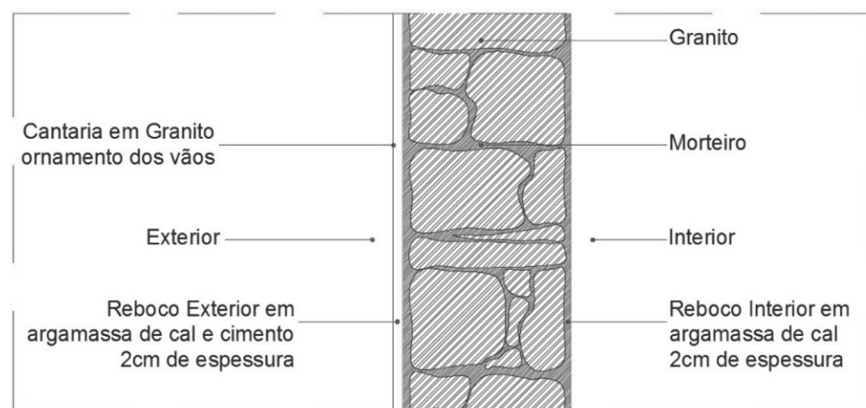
Pormenor parede portante (s/escala) – (Autor)
